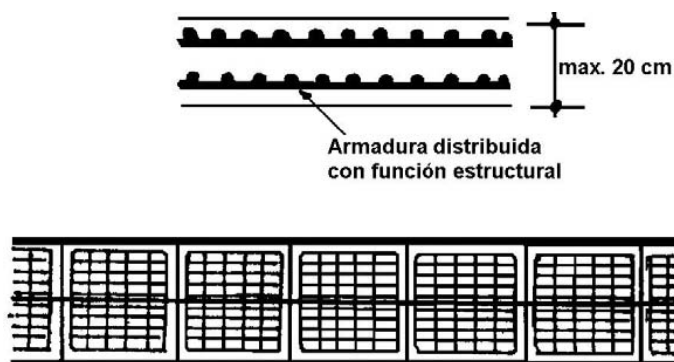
a. Pavimentos de Concreto Reforzado con Fibras.
